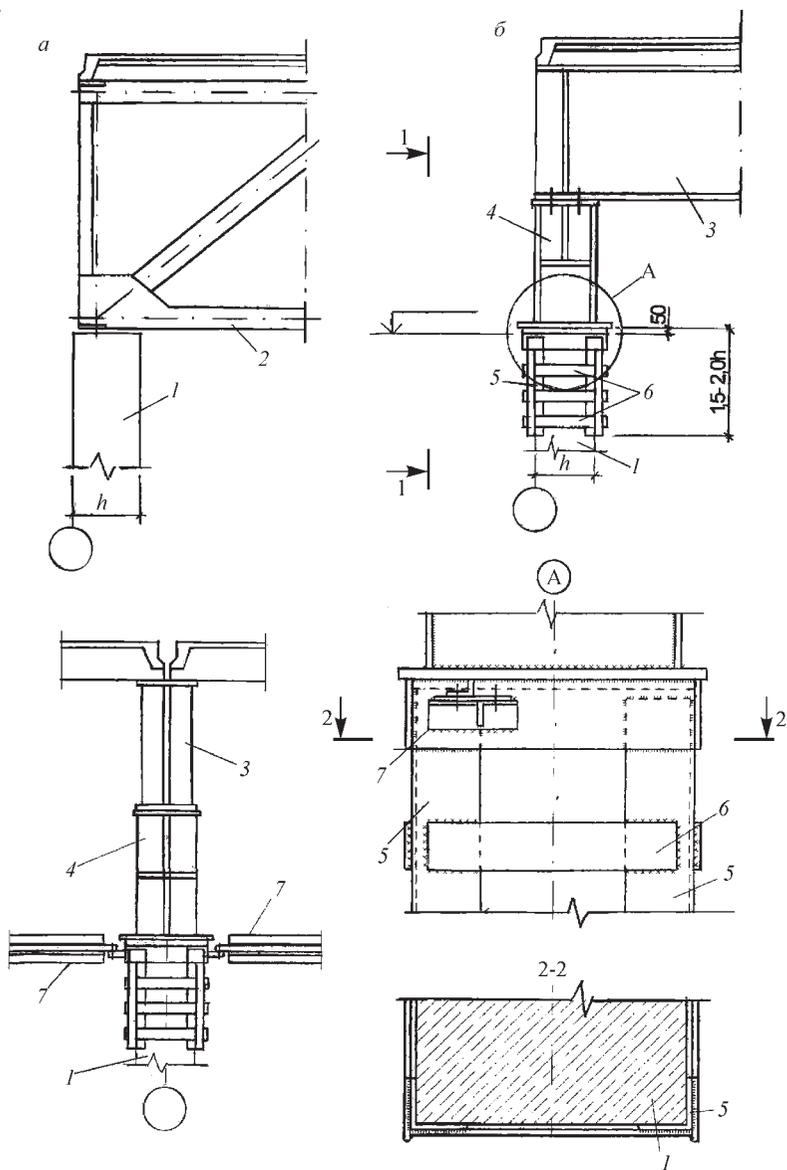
Замена железобетонной фермы стальной балкой:
